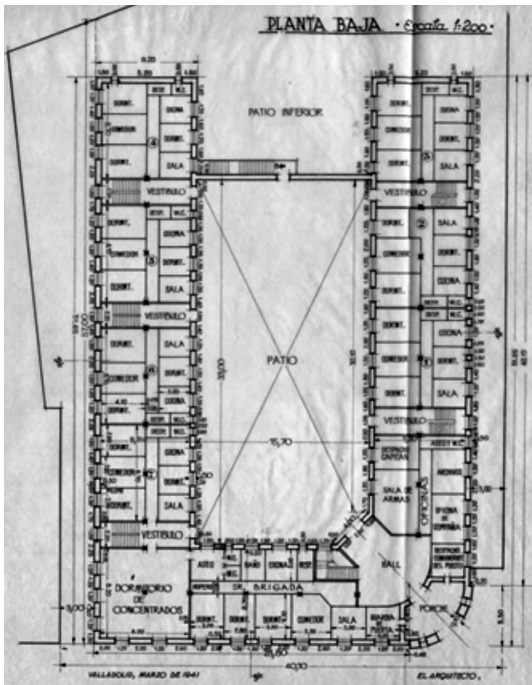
Planta del Cuartel de la Guardia Civil, Benavente (Zamora), 1941 (no construido). AFMB
